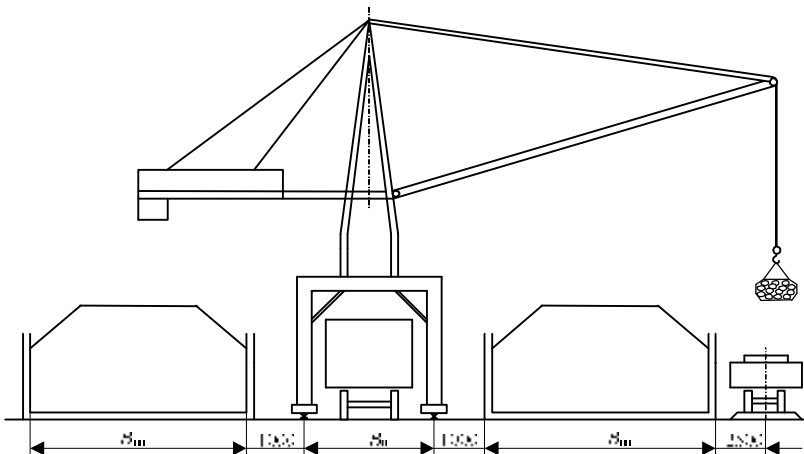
Схема механизированной погрузки, выгрузки грузов башенным краном, оборудованным стропами или рейферным захватом
